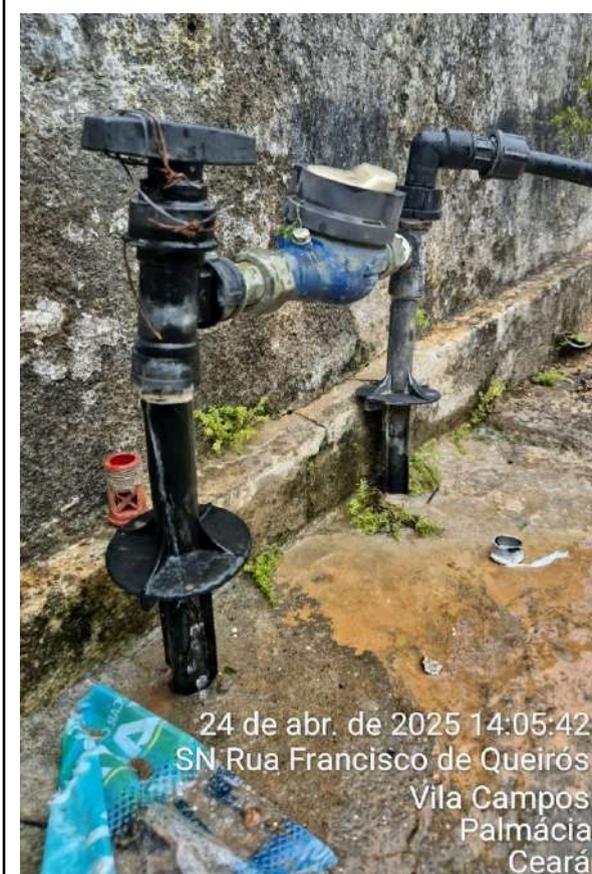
EEE-01: vazamento elevado na torneira do hidrômetro e na tubulação.
